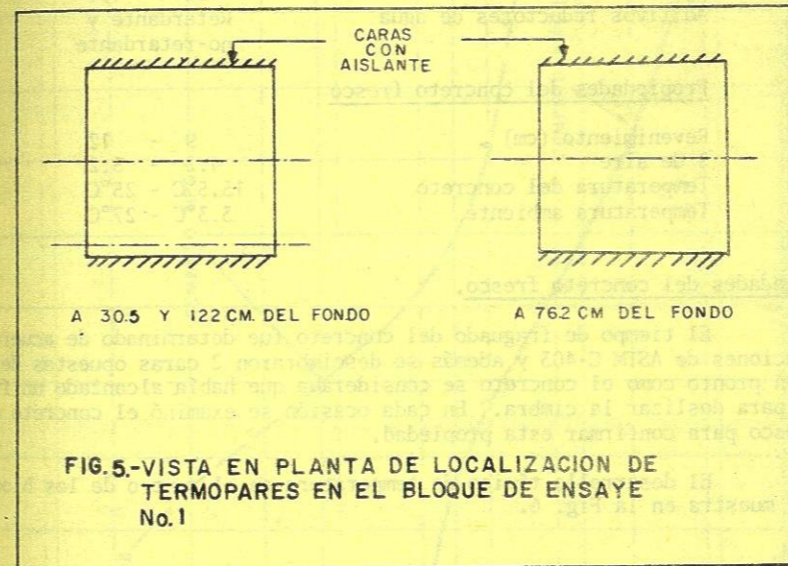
VISTA EN PLANTA DE LOCALIZACION DE TERMOPARES EN EL BLOQUE DE ENSAYE No. 1
